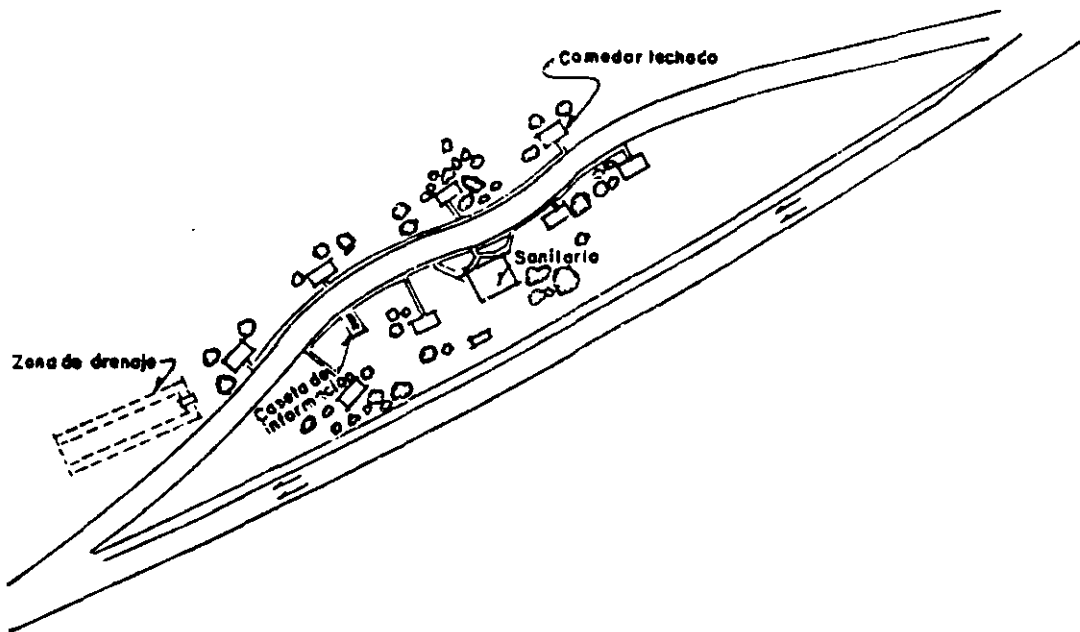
ZONA DE DESCANSO DE TIPO SIMPLE CUYO CAMINO DE ACCESO ES LO SUFICIENTEMENTE ANCHO PARA PERMITIR EL ESTACIONAMIENTO PARALELO EN AMBOS COSTADOS
